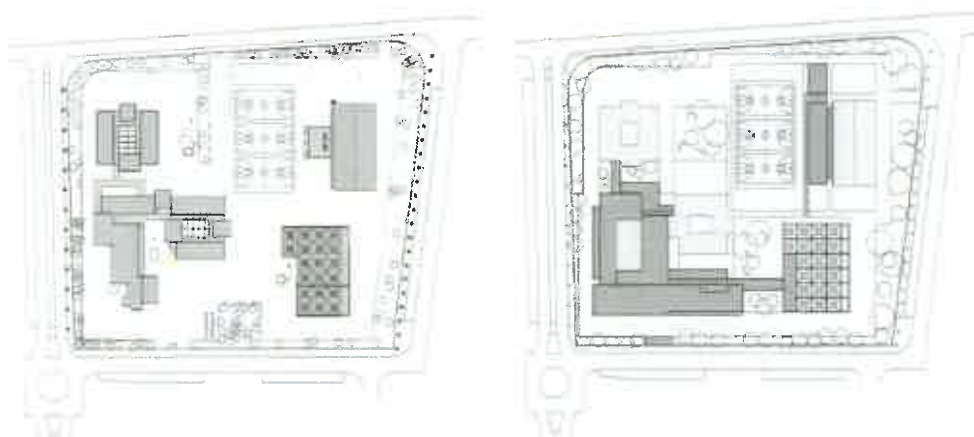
Esquerda: Plano do Existente; Direita: Plano da Proposta
